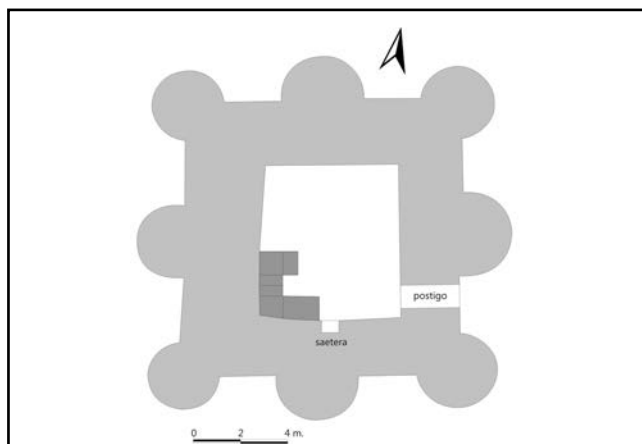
Hipótesis de reconstrucción de la planta sótano de la torre del homenaje.
